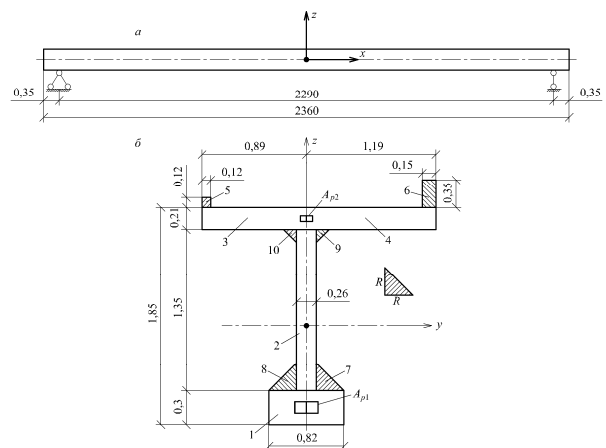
Конструкция железобетонного пролетного строения 22,9 м:
